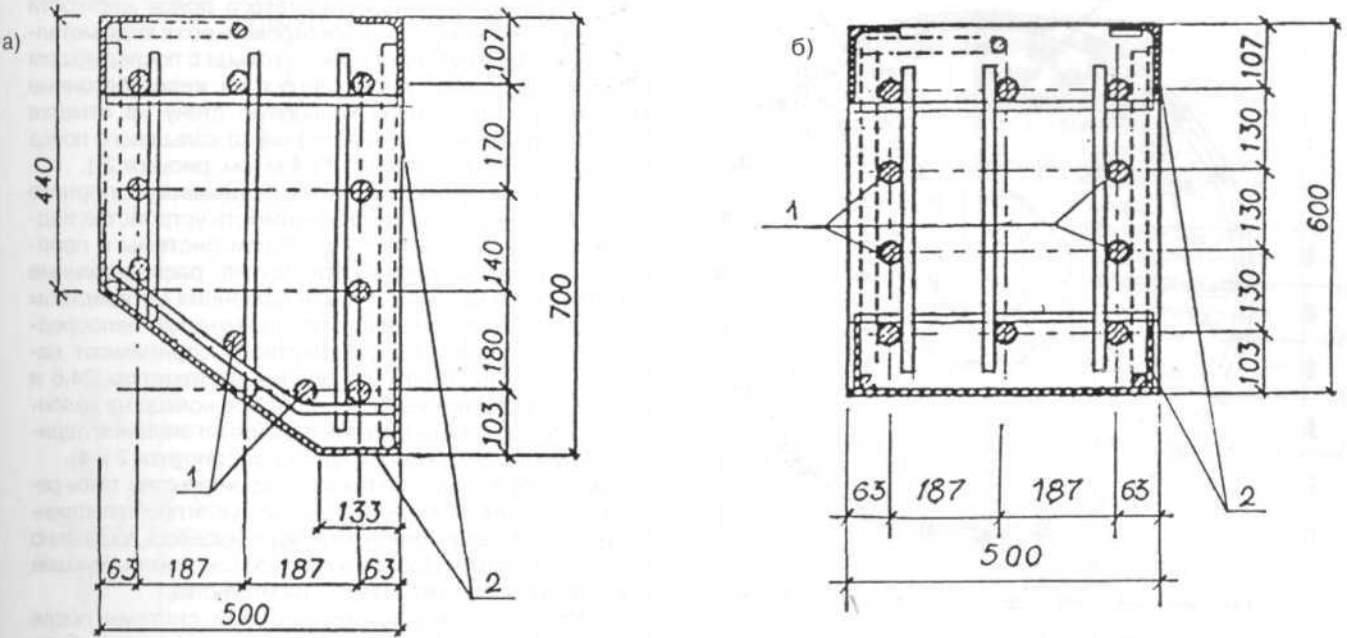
Поддерживающие опоры системы кружал (см. рисунок 11, разрез 1-1)
